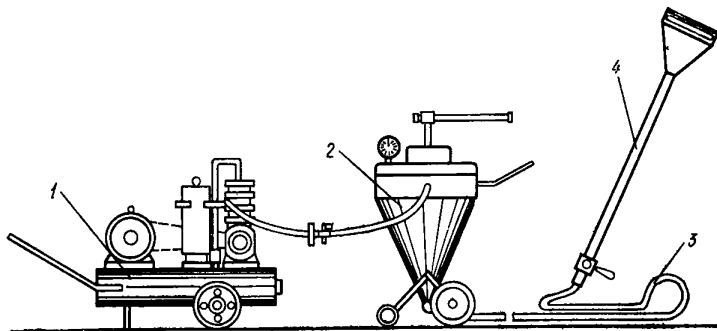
Общая схема комплекта оборудования для механизированного нанесения гидроизоляционного материала внутрь щели
